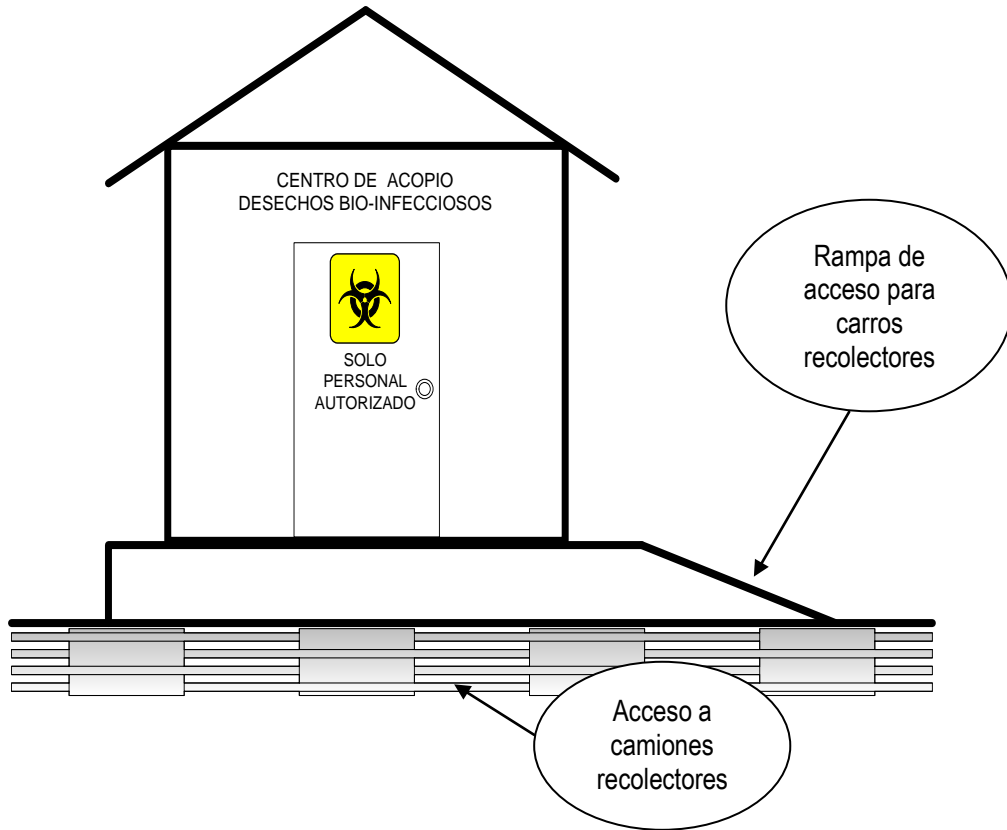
Vista en planta de un modelo de centro de acopio
